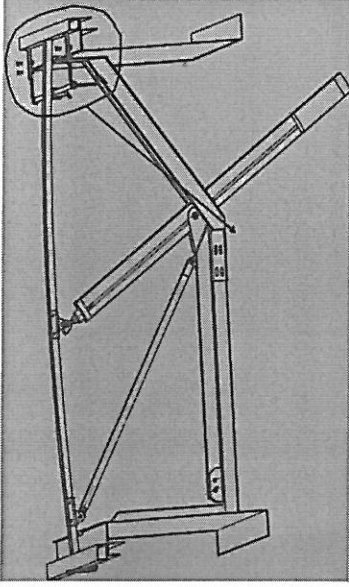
Montaż mechanizmu oddymiającego w podstawie
